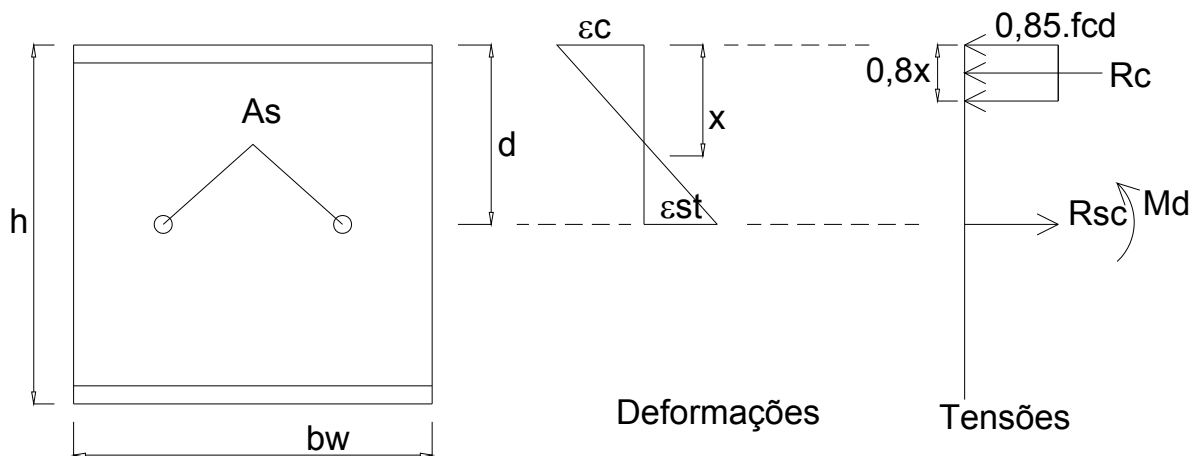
Equilíbrio da seção da ligação viga-pilar.
